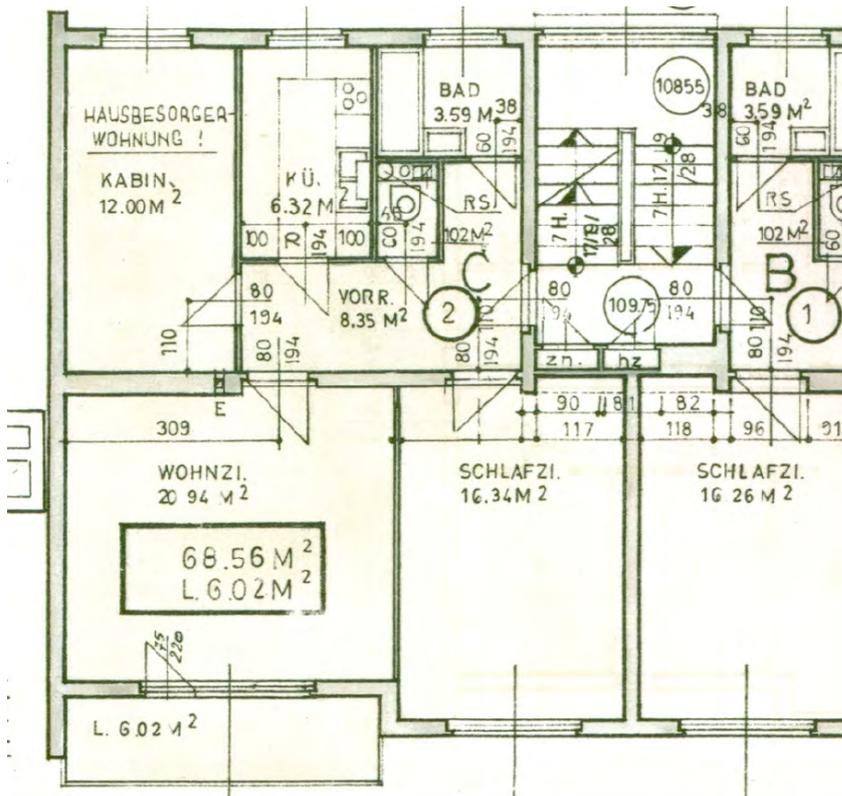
Anzbachgasse 31/27-29 2. Obergeschoß Behördenplan
